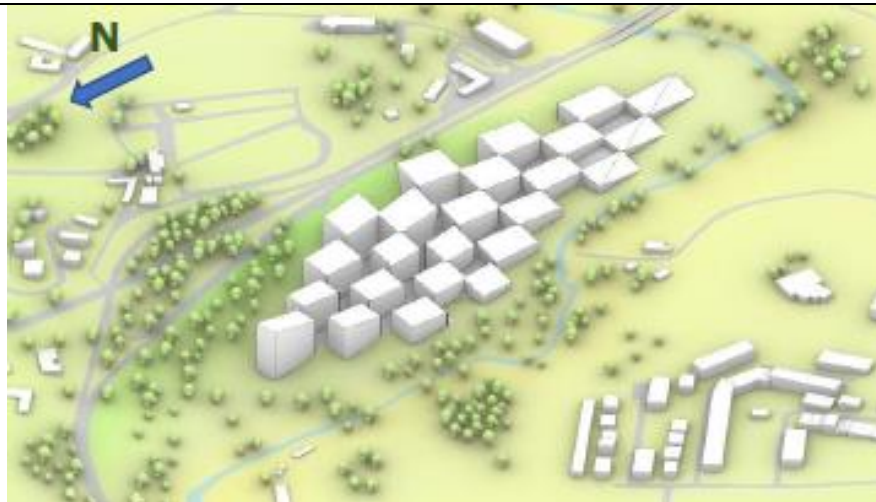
Morfologia do edificado (Fonte: Aditamento ao EIA - outubro de 2021).
